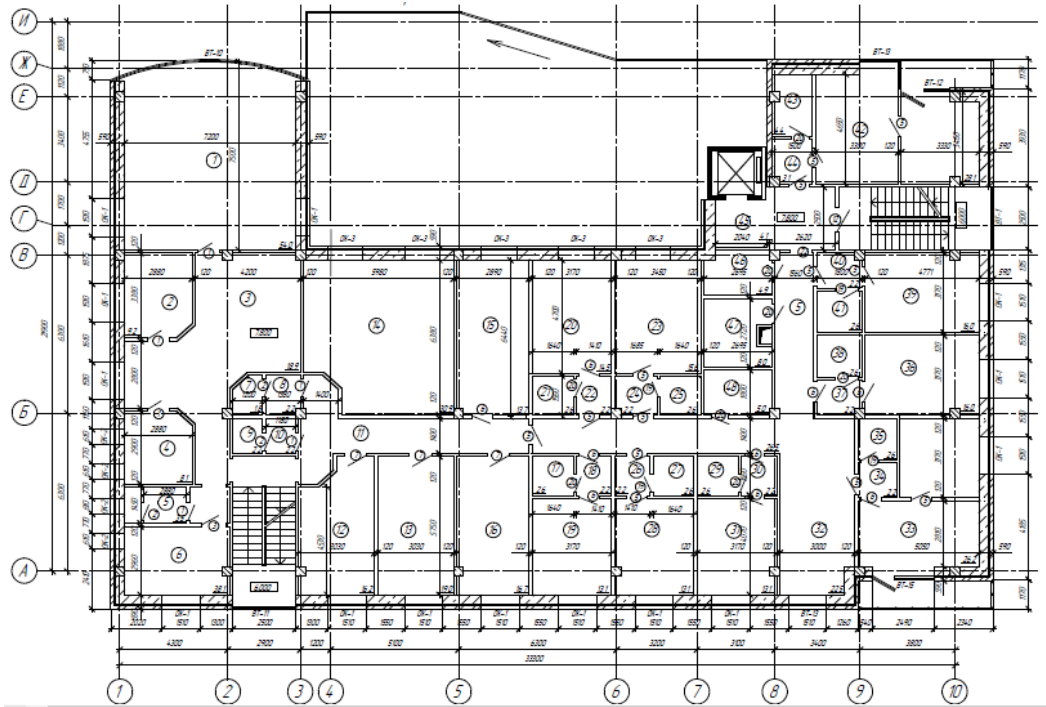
План третьего этажа на отметке плюс 7.800
